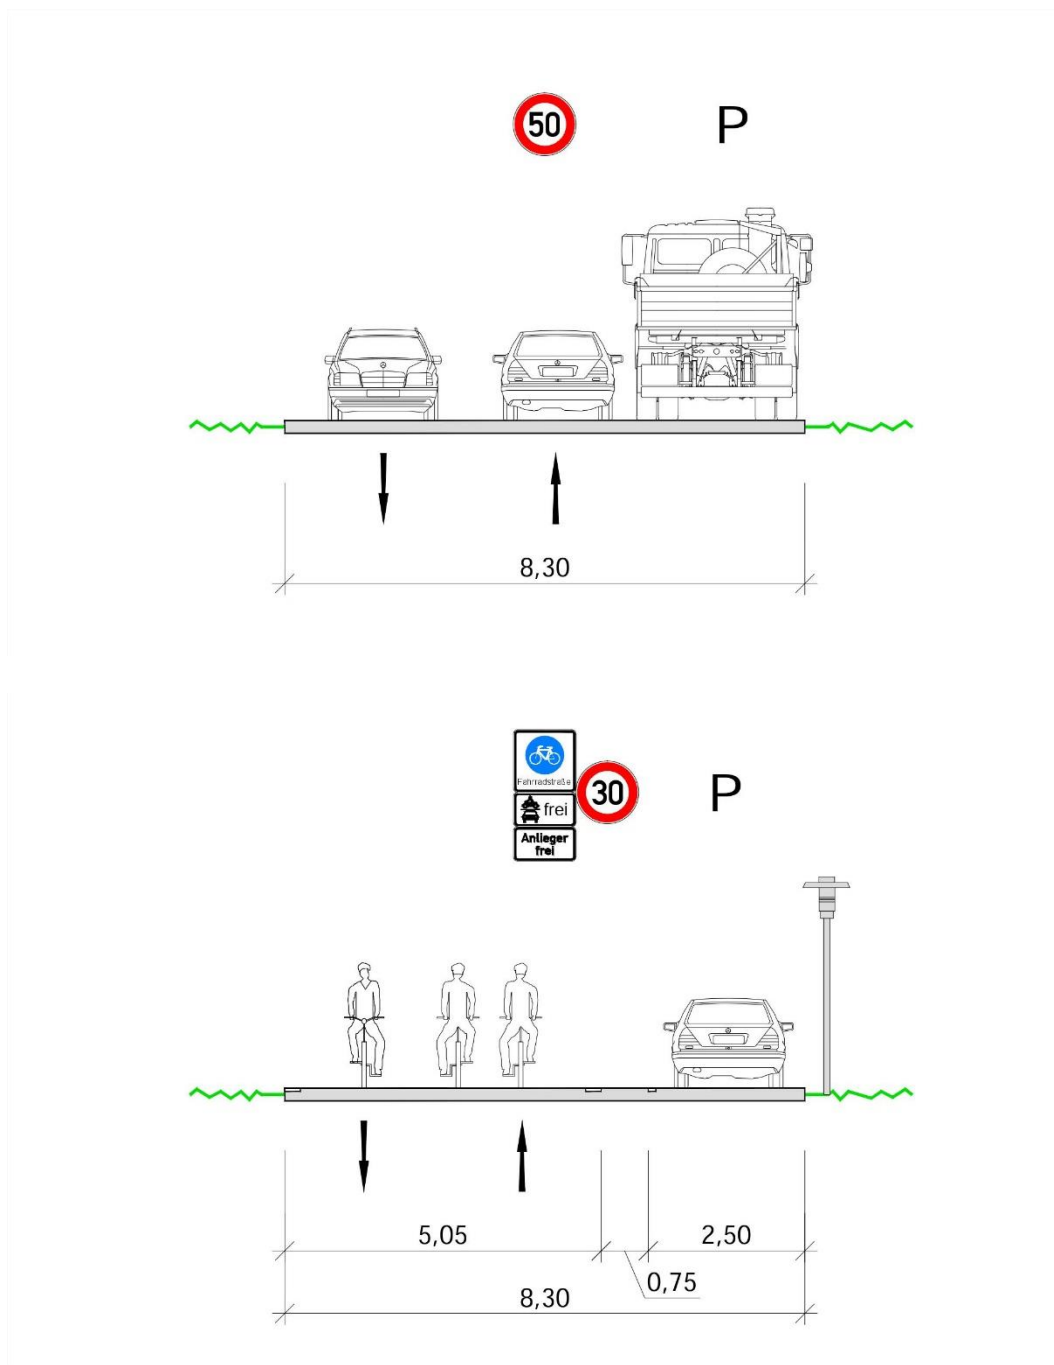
Zubringer Ingolstädter Landstraße (Gerlachstraße bis Waldweg) – Bestand (oben) und Planung (unten)
